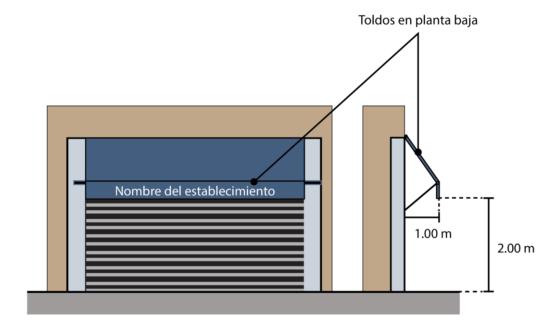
Ilustración en alzado de un toldo en planta baja dentro de la Norma.
